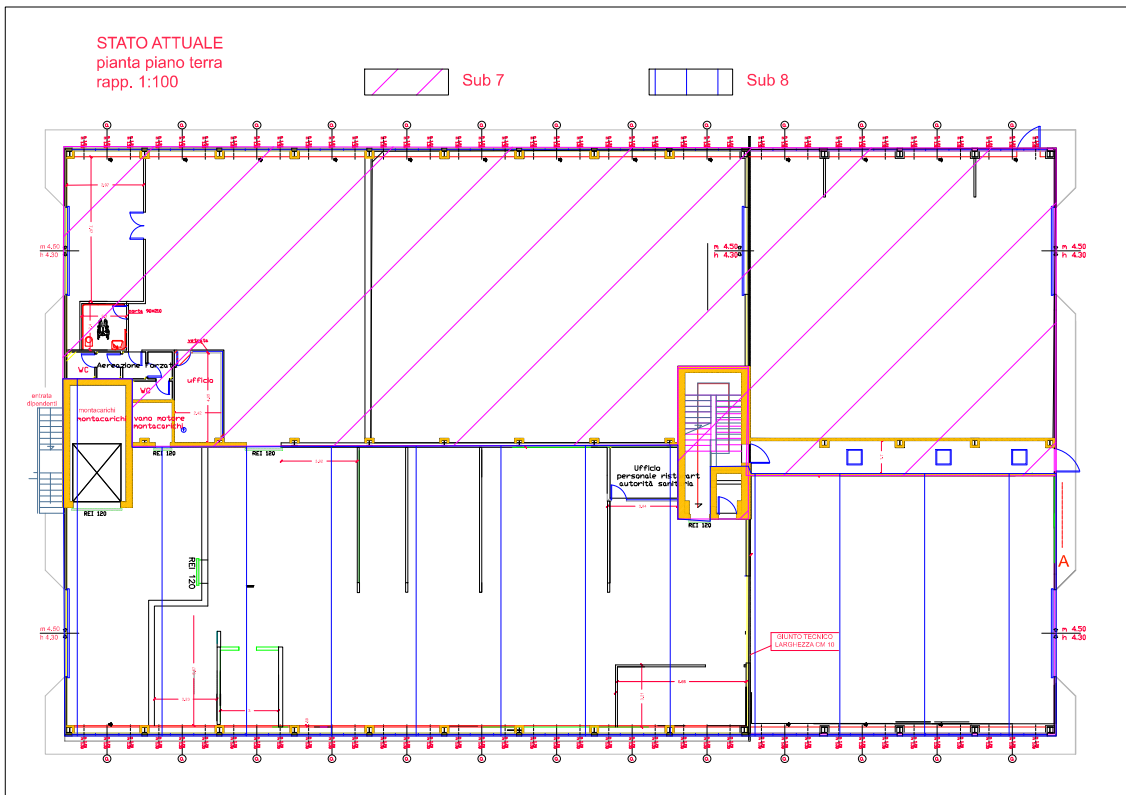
Planimetria rilevata Piano terra con individuazione sub 7 e sub 8
